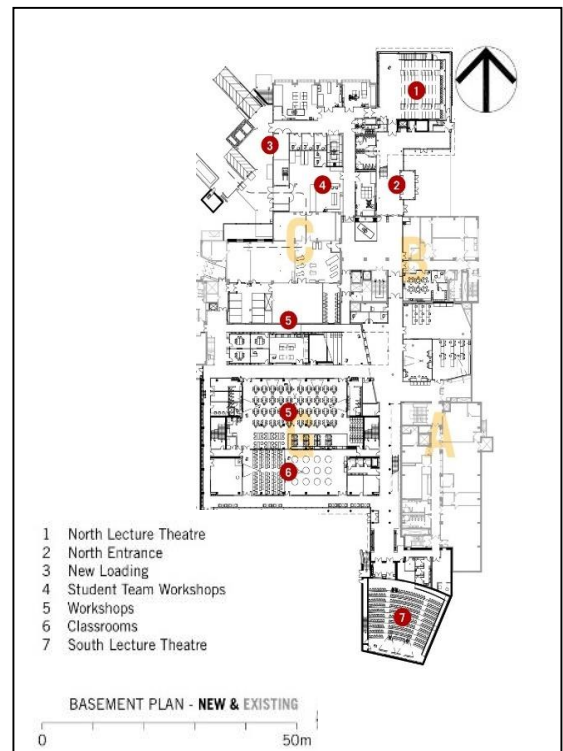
plan RDC de Schulich School of Engineering Redevelopment and Expansion.
